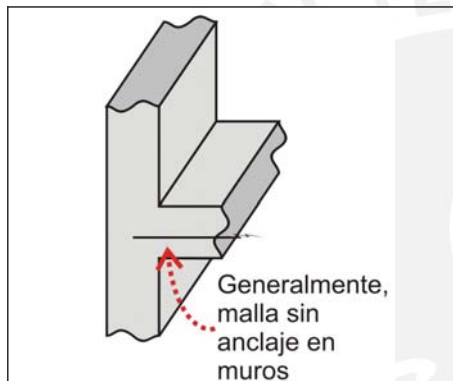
Anclaje de Malla de Losas en Muros
